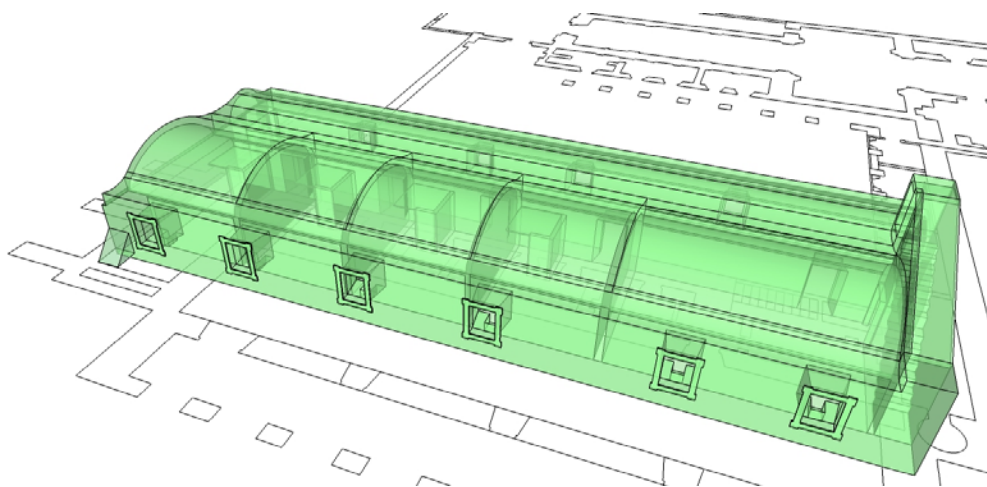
Reconstrucción Virtual del Sector 3 b: Ala Norte Planta Alta
